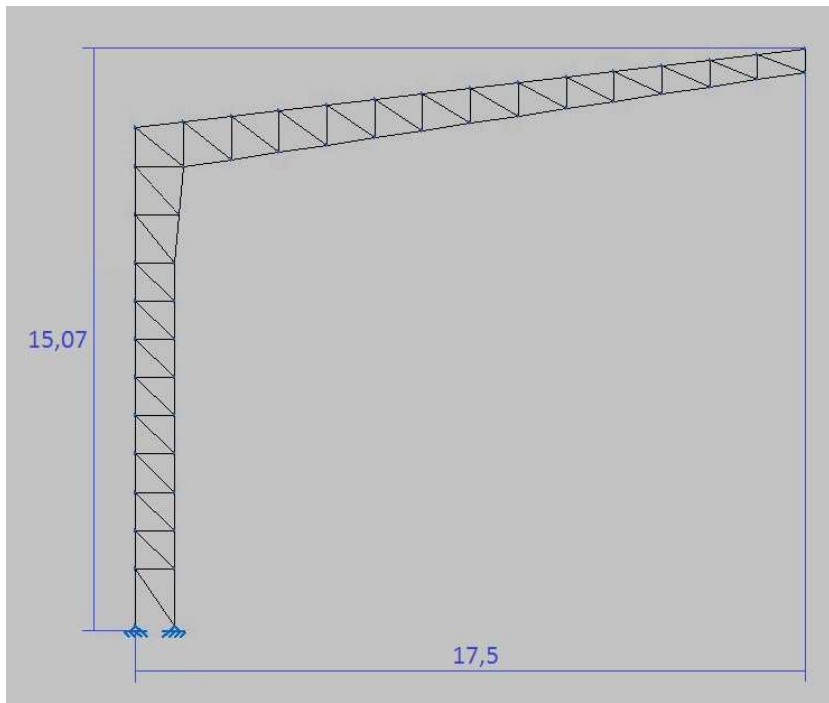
Pórtico de la cubierta metálica (dimensiones en m)
